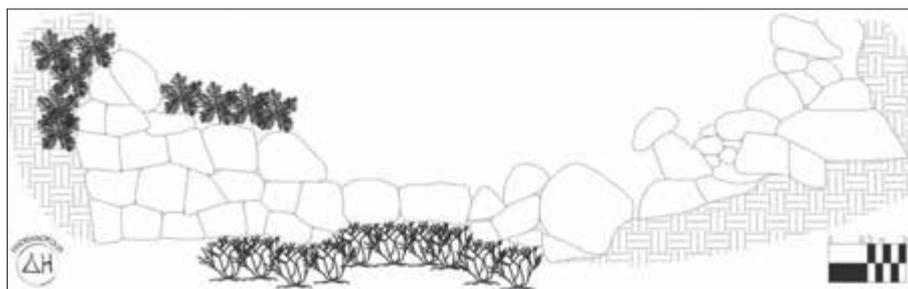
Lekel, prospetto della parte delle mura in opera poligonale.
